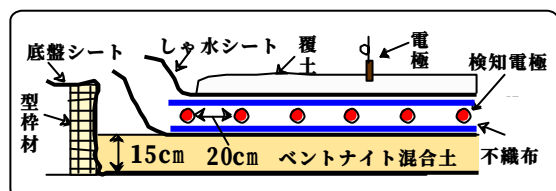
二重しゃ水シート構造の場合における実験モデルー断面図
